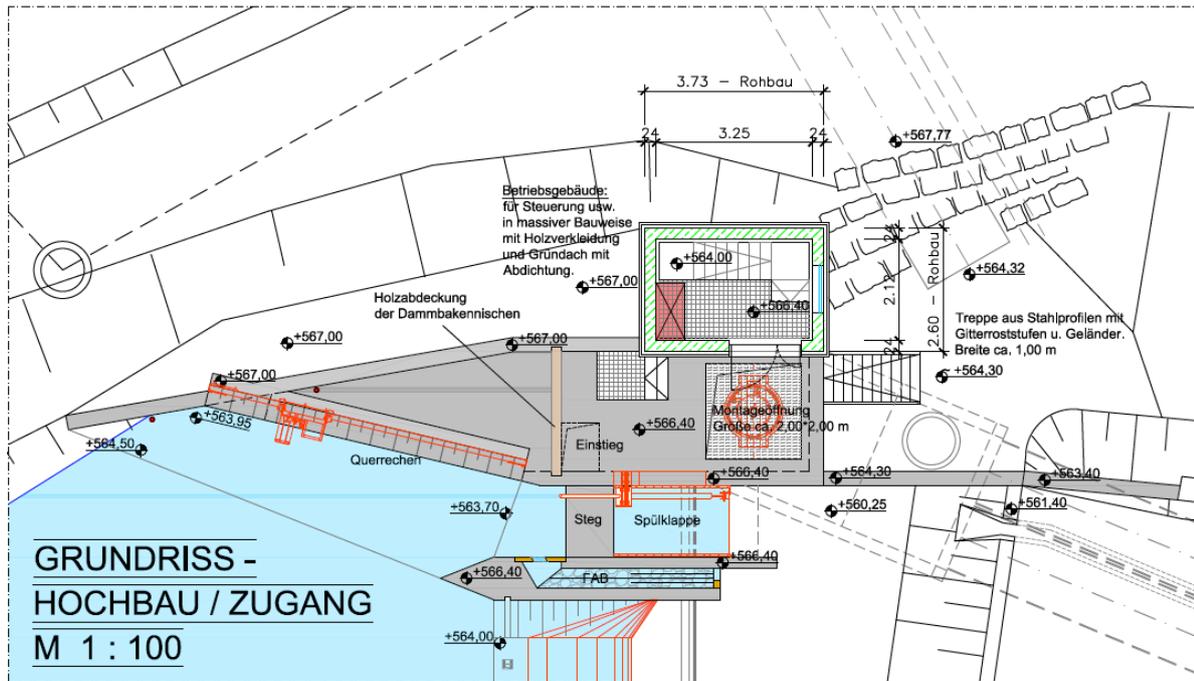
Grundriss Hochbau/Zugang – Planung (Auszug Planung IB Ederer 2018)
